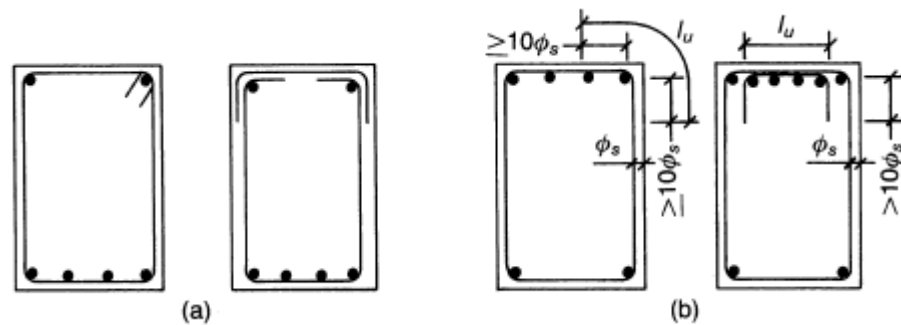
Possíveis soluções de pormenorização. (a) estribo em zona de compressão. (b) estribo em zona tracionada. [9]
